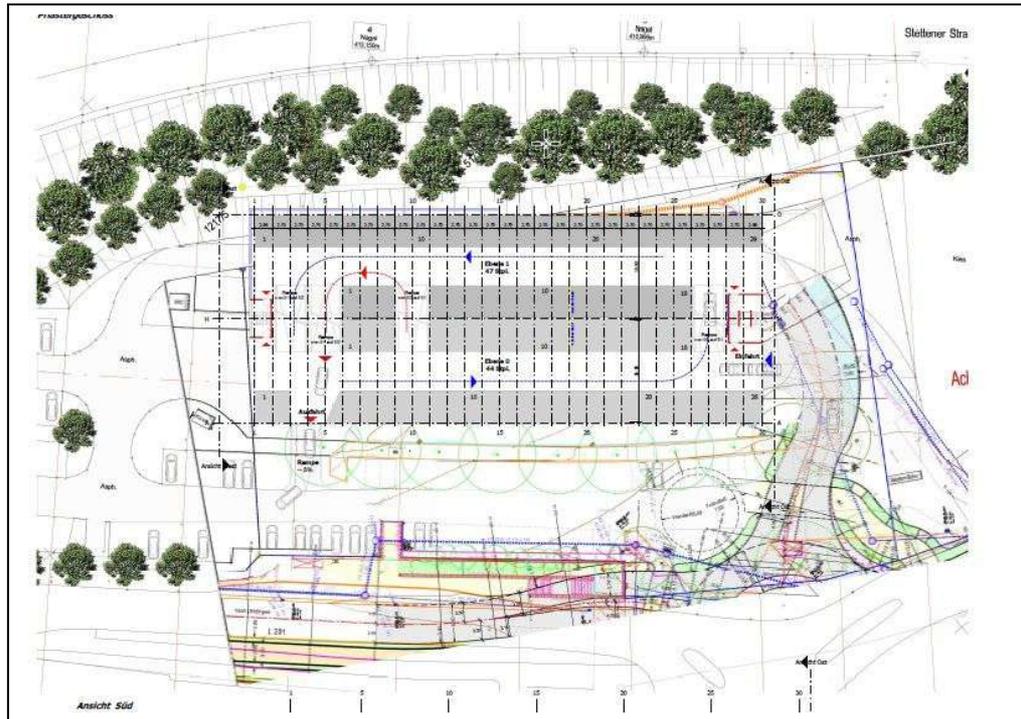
Bebauungsplan „Bebauungsplan Chorherrenhalde“ in Meersburg (STADT MEERSBURG in lit. 2018)
